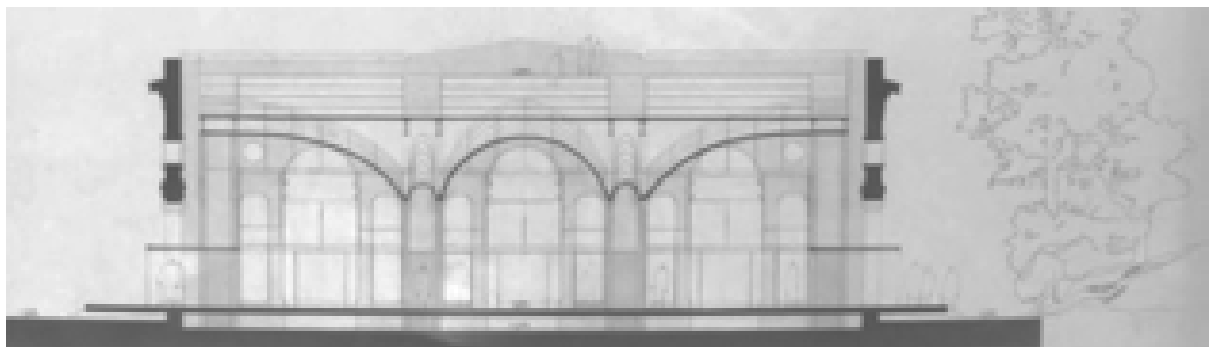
Studio di sezione B – stato futuro (AABS-968)
